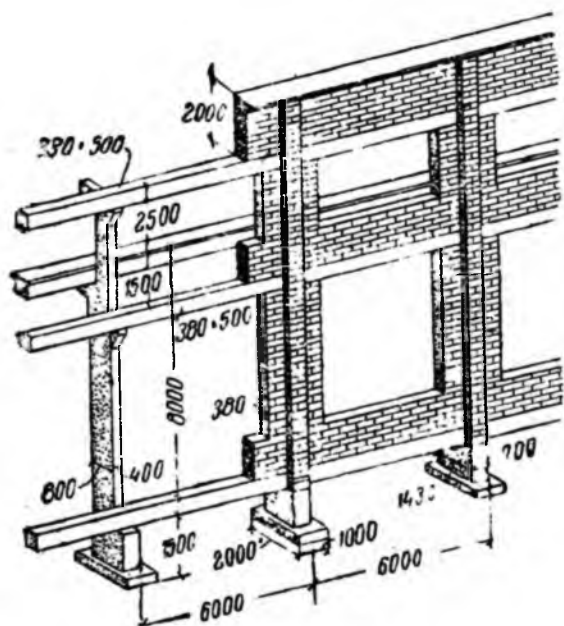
Железобетонный каркас стены одноэтажного промышленного здания с кранами
